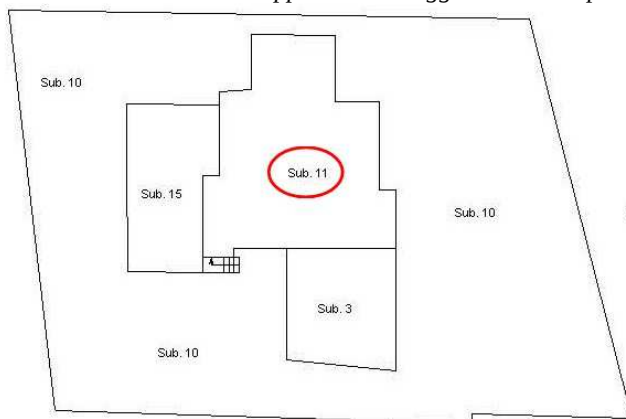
Elaborato planimetrico part. 1046 dove è collocato l'appartamento oggetto di stima
